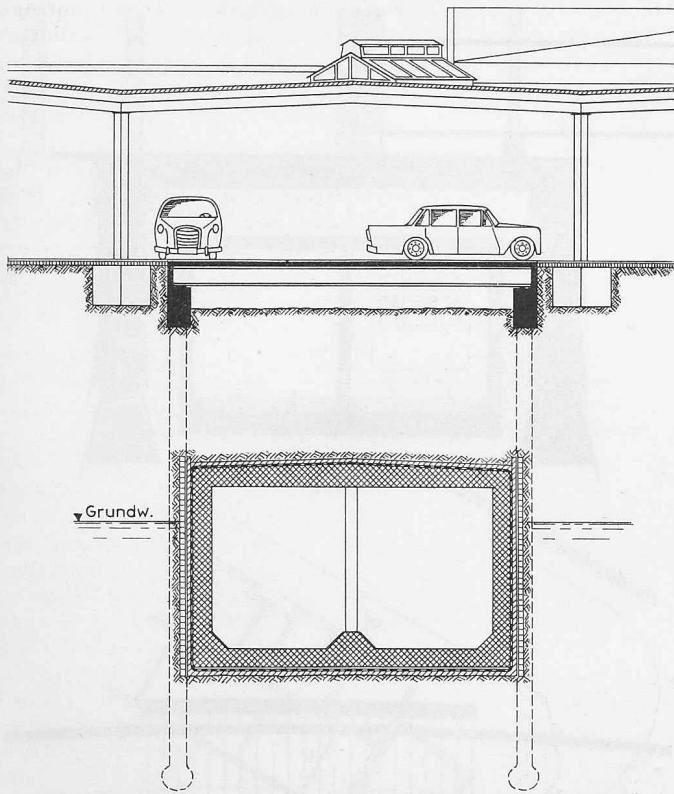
Unterfahrung einer Kraftfahrzeughalle, Schnitt 1:200
